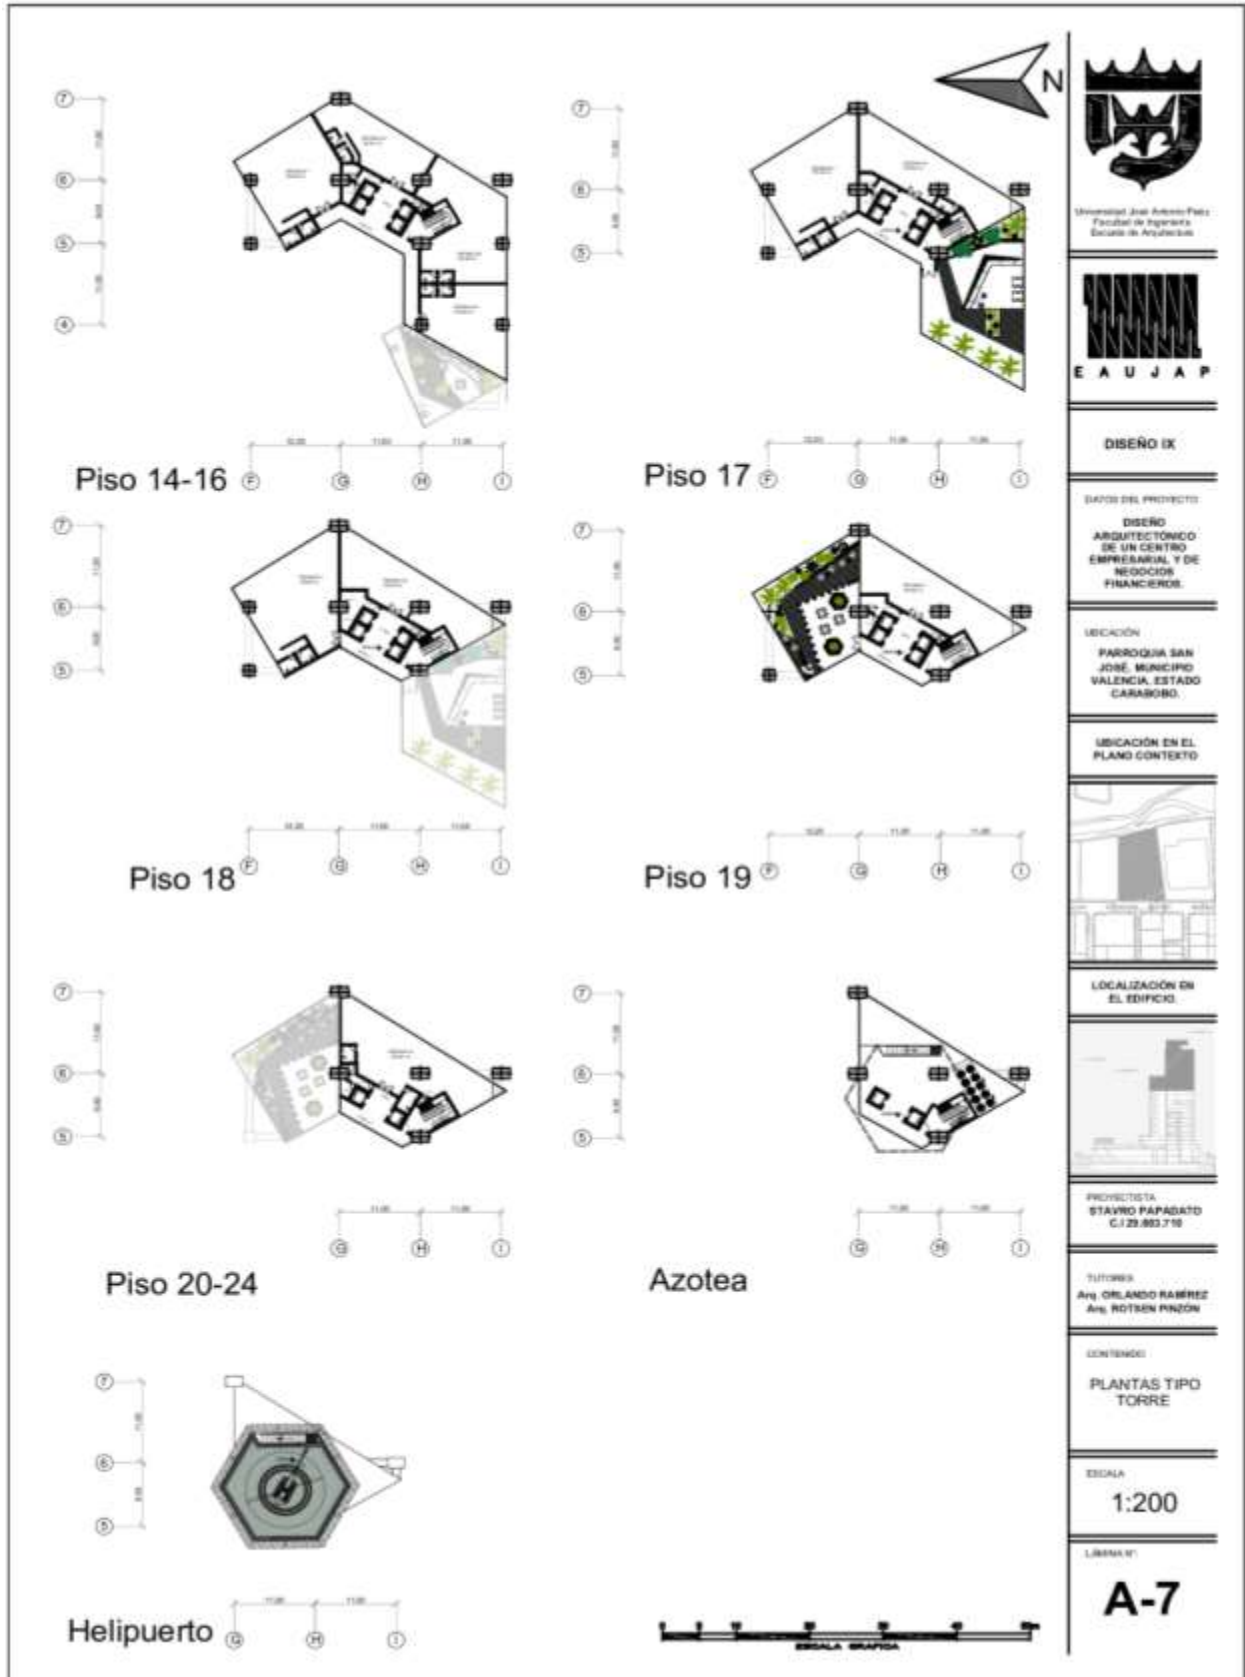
A – 7 Plantas Tipo Torre Piso 14 hasta el Helipuerto Fuente: El Autor (2023)
